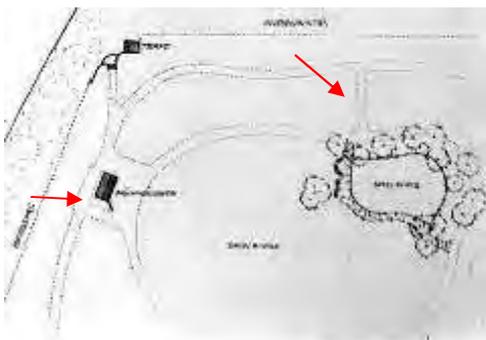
„Kinderspielplatz im Stadtpark“, Plan-Ausschnitt 1957
